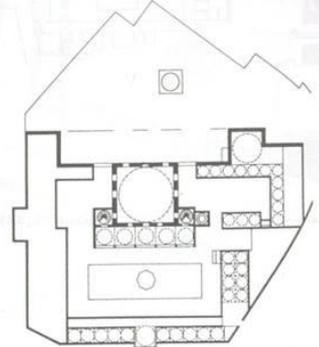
مسقط أفقي للجامع الأقصى الحالي . (عن ، كريزول).
